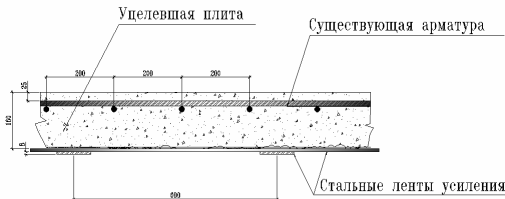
Принципиальная схема усиления поврежденного перекрытия
